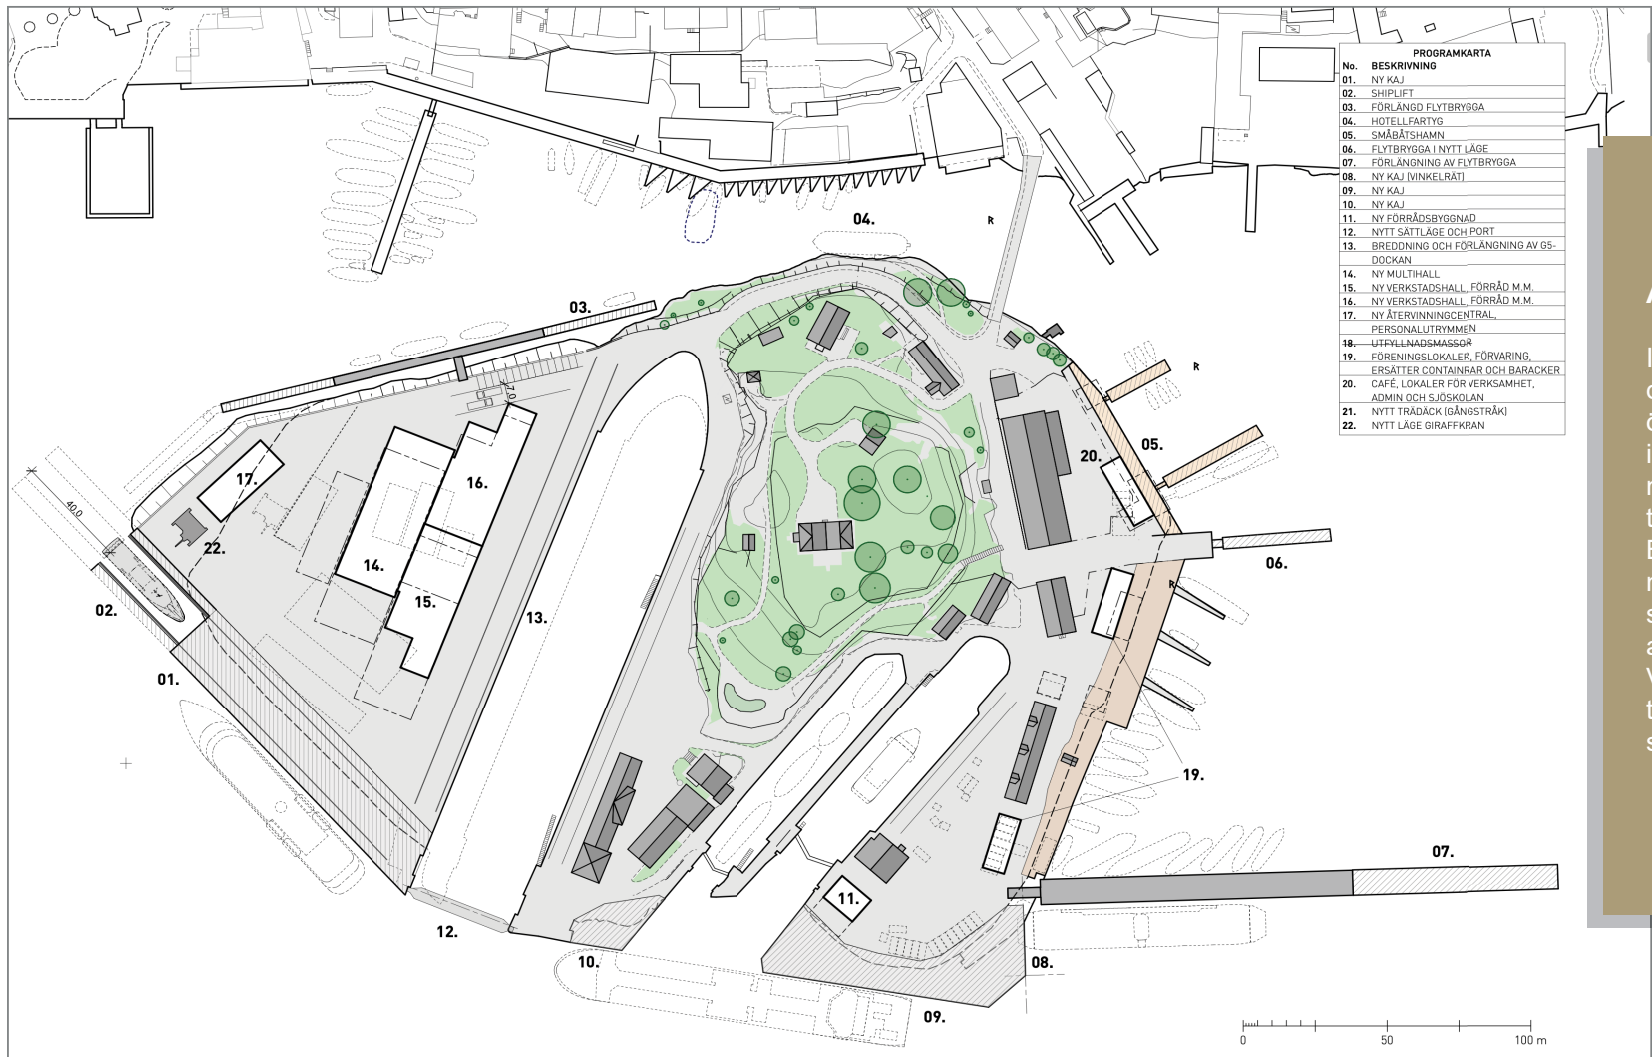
Situationsplan för planområdet (förenklad), Fahlander Arkitekter 2023-04-21.
